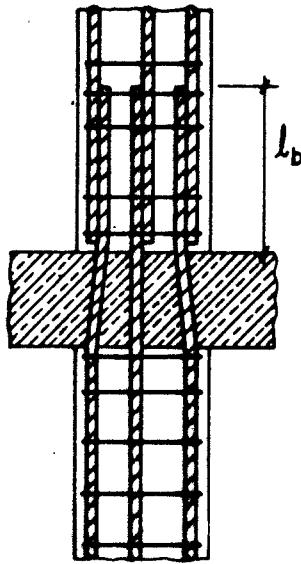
Emendas por traspasse junto a lajes de piso - pilar com seção constante^[20].
